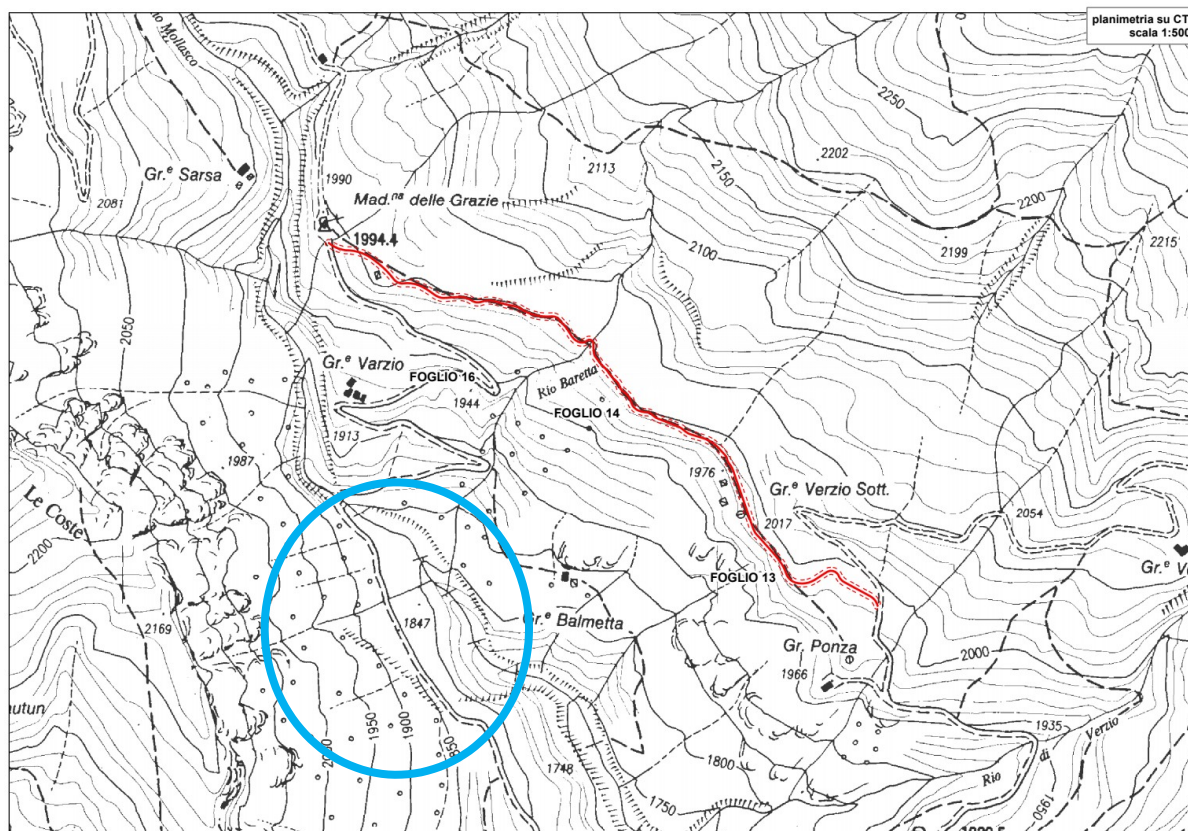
Corografia e localizzazione della pista. Il cerchio blu indica la zona ad elevato rischio di caduta massi.
